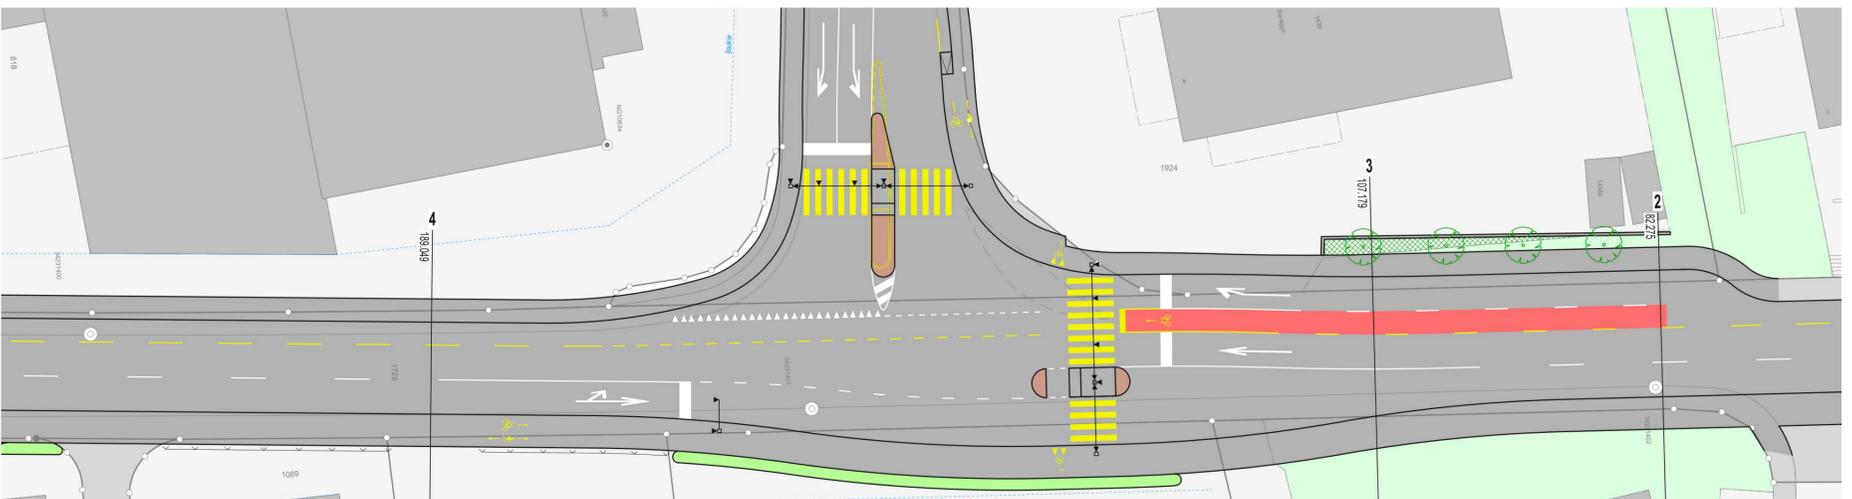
Ausschnitt aus dem Markierungsplan (Knoten Zeughausstrasse / Moosgasse)
